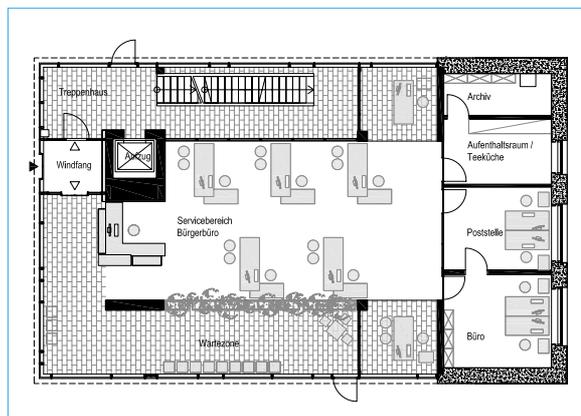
Grundriss des Bürgerbüros im Erdgeschoss
